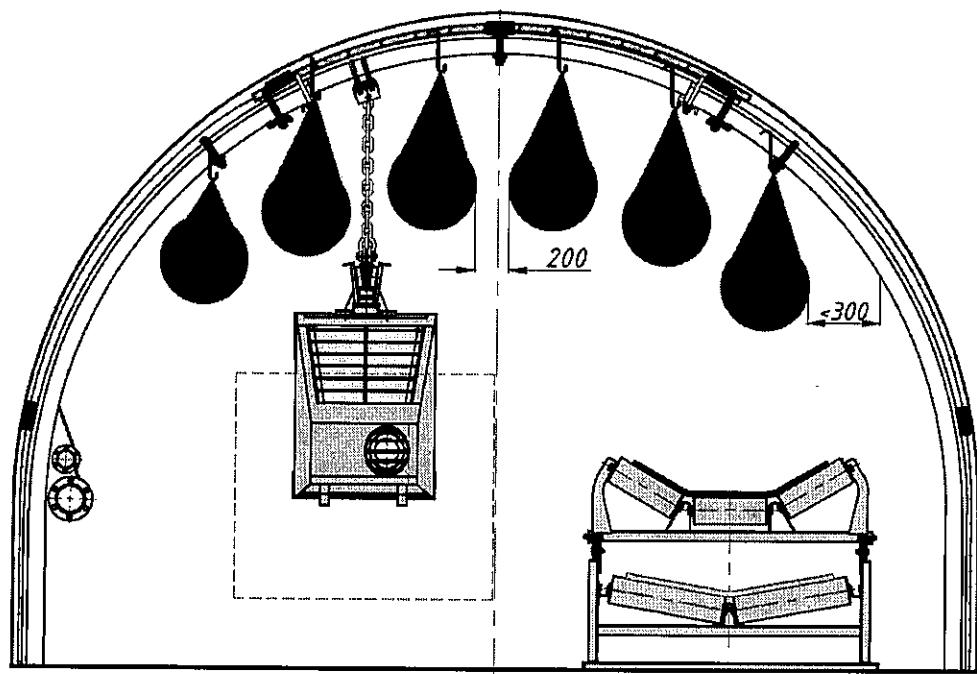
Схема установки сланцевых заслонов (пленочных бесшовных сосудов) в горных выработках
